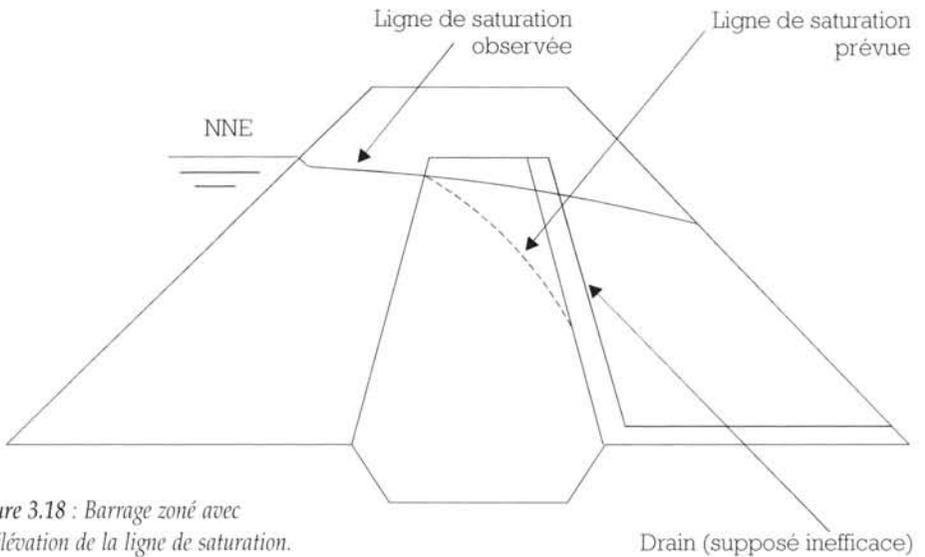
Barrage zoné avec surélévation de la ligne de saturation.
